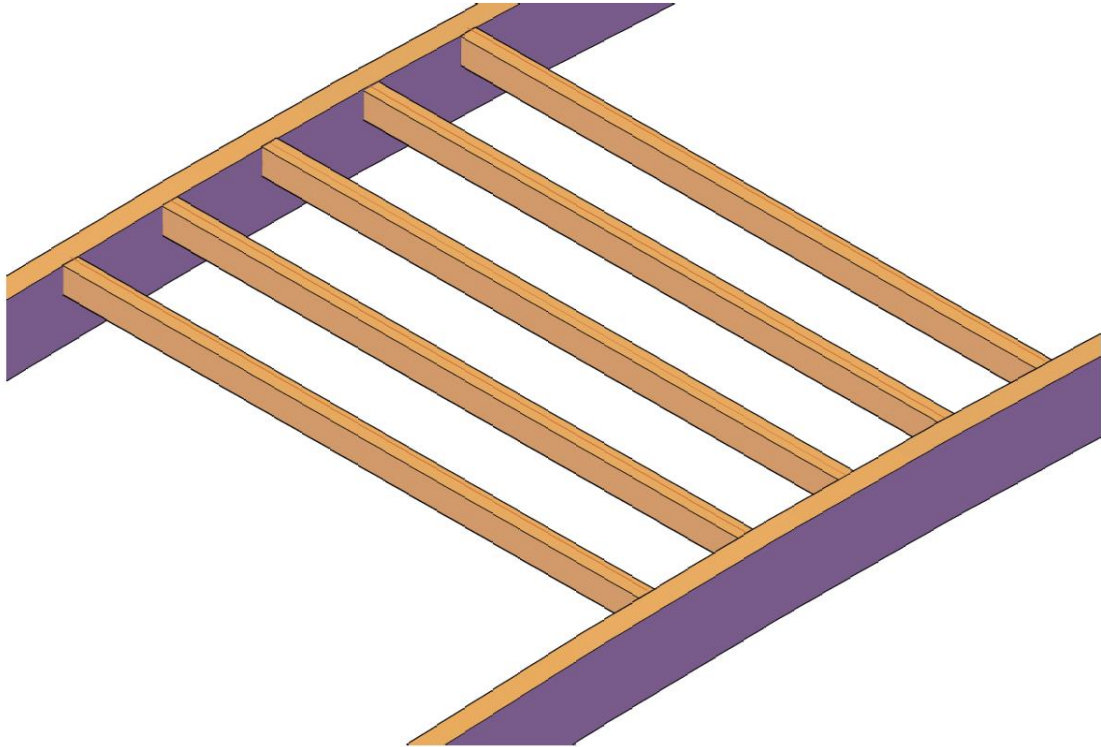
Detalle del encaje de vigas con correas. Fuente propia.
